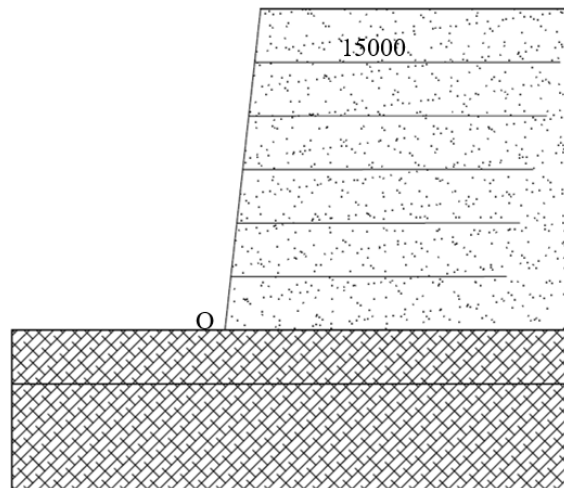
Desain Dinding Penahan Tanah Gravity Wall
